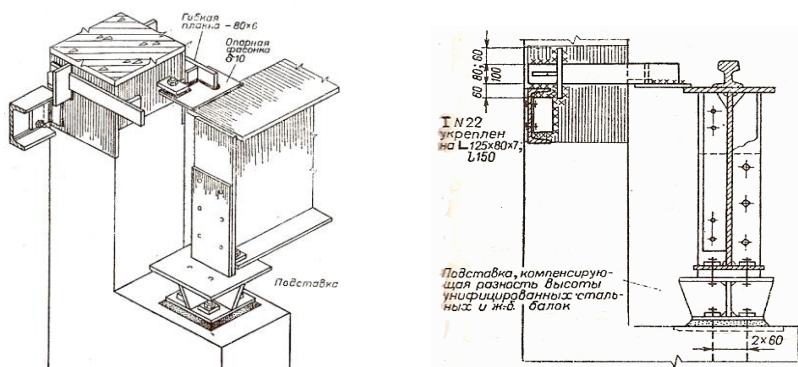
Крепление стальных подкрановых балок к железобетонным колоннам
